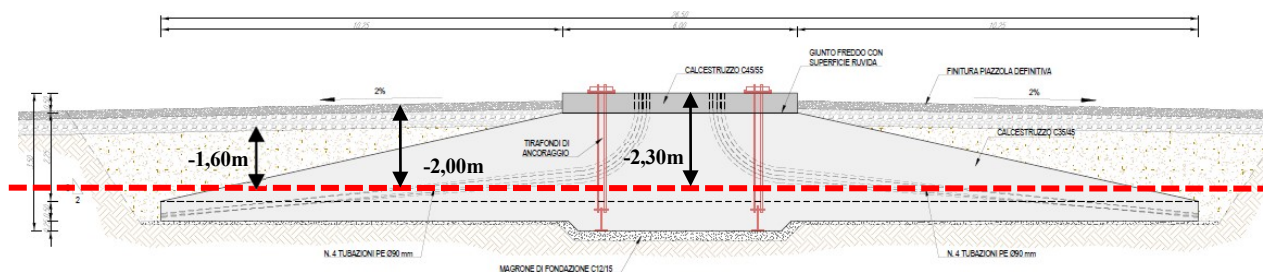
Schema della dismissione del plinto della fondazione, fino a -2,0 m dal piano campagna finale di progetto.
